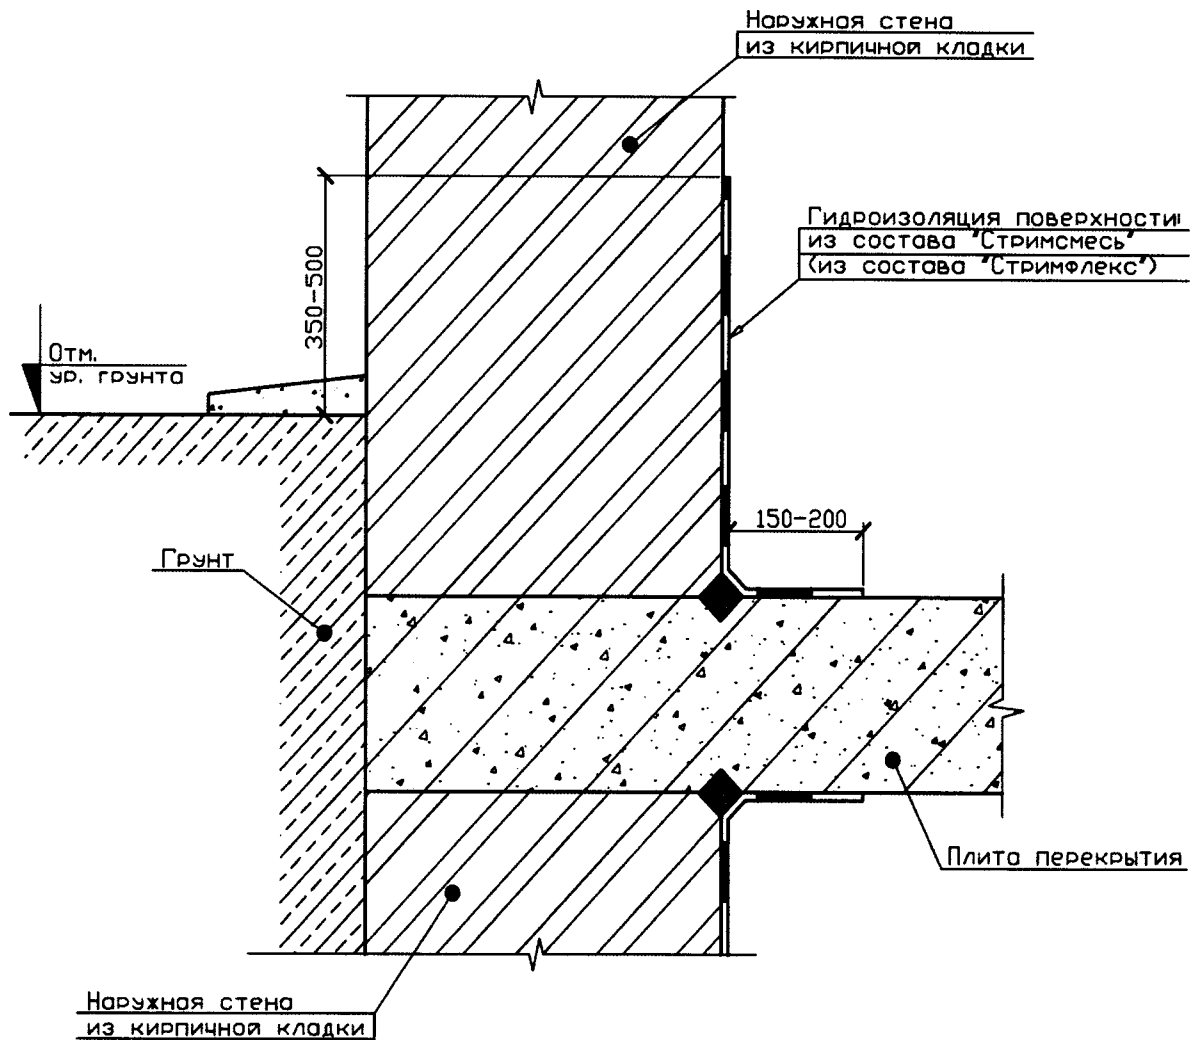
Гидроизоляция поверхностей конструкций из кирпичной кладки. Гидроизоляция поверхностей наружных стен из кирпичной кладки в зоне отметки уровня грунта
